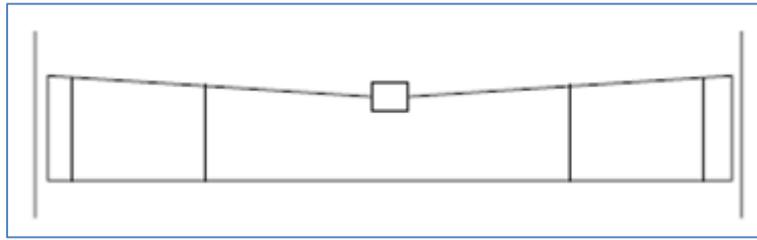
Toit type double pont (le caisson recouvre toute la surface du bac [3]).
